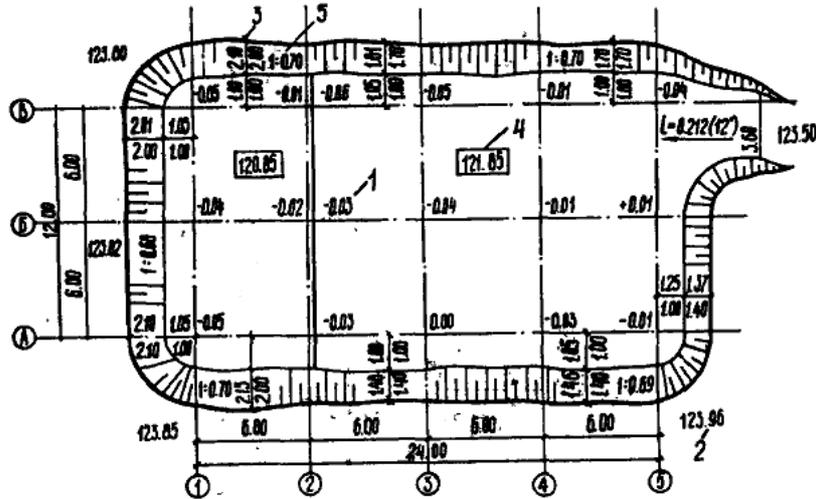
Исполнительная схема планово-высотной съёмки котлована:
